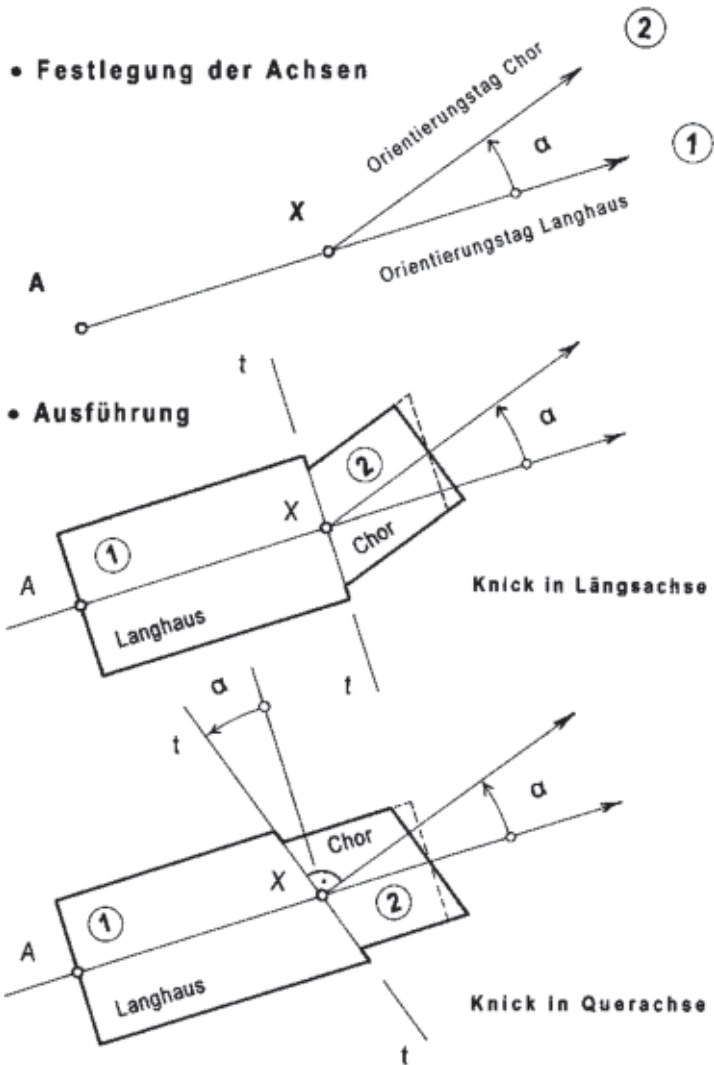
Orientierung und Absteckung von Kirchengrundrissen
